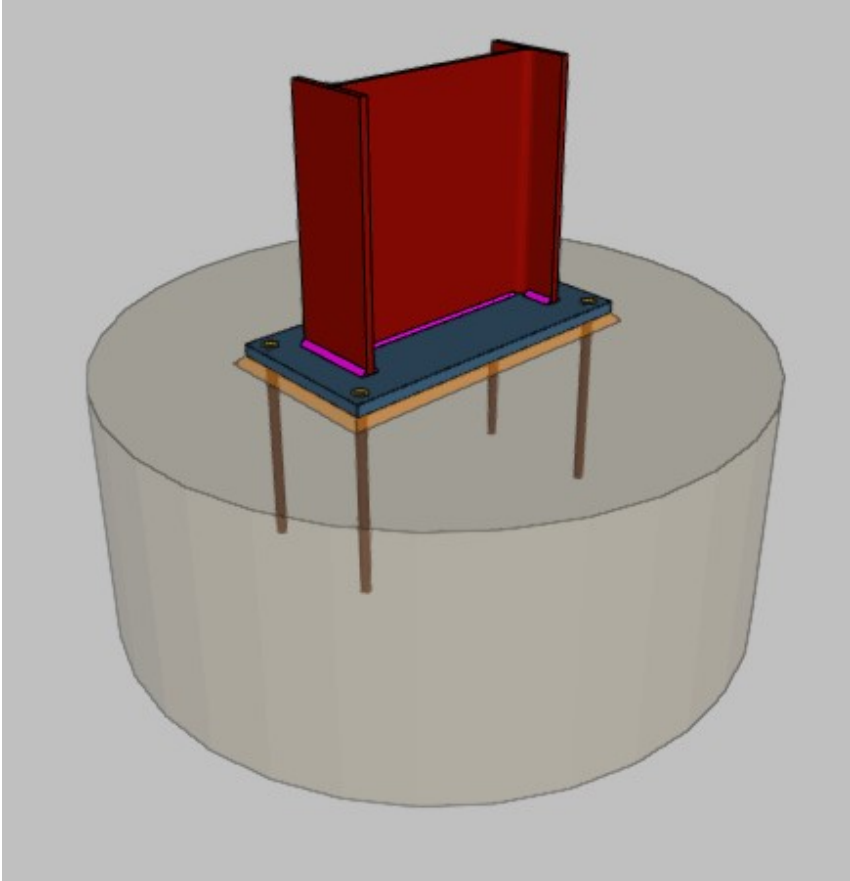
“Detalle de cimentación.. CYPE 3D. Fuente: Propia.”
